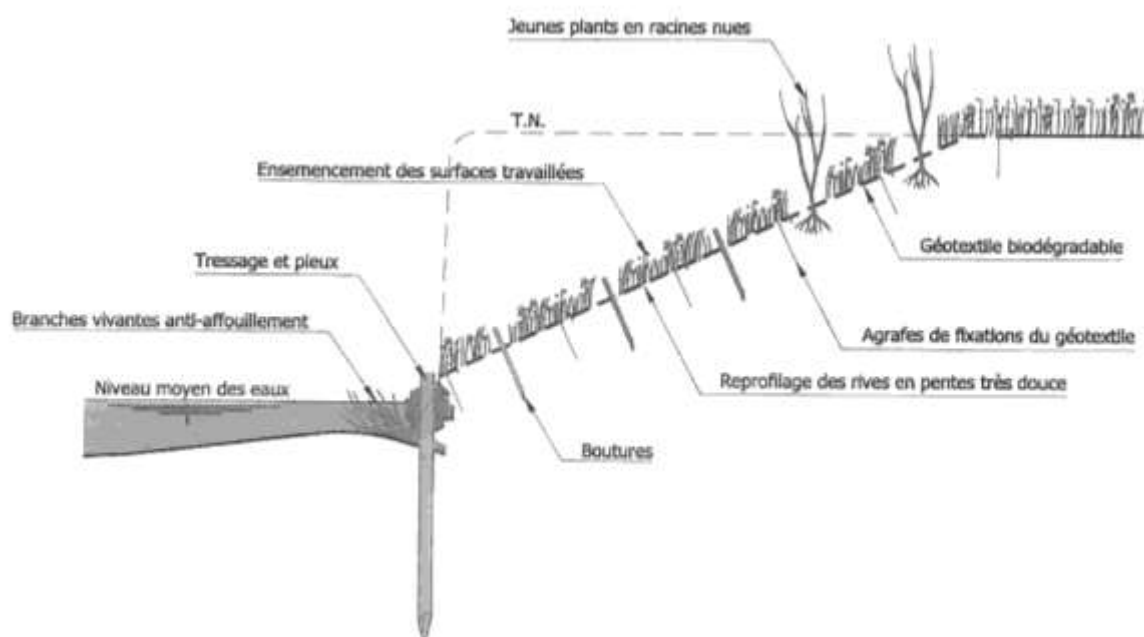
Profil en travers d'un tressage consolidé par des boutures (SILENE BIOTEC)
